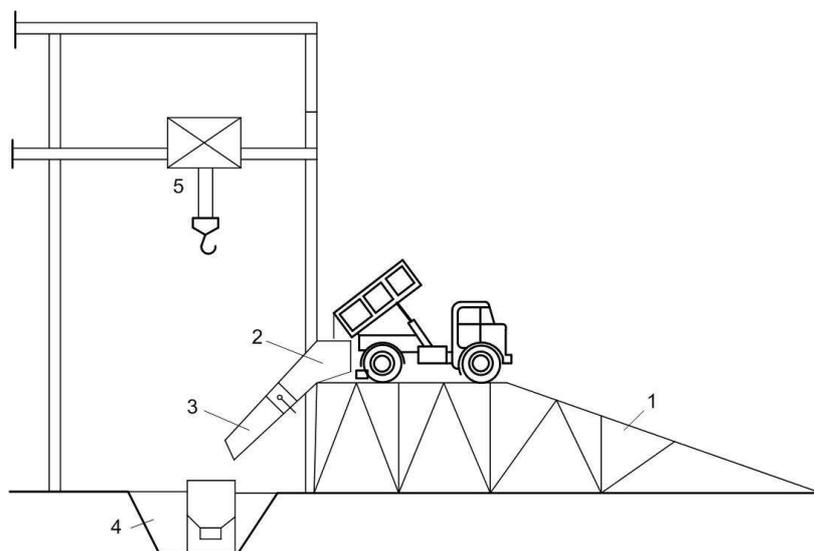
Подача бетонной смеси мостовым краном: 1 – эстакада; 2 – приемное устройство; 3 – перегрузочный лоток; 4 – приямок для бункера; 5 – мостовой кран для транспортировки
